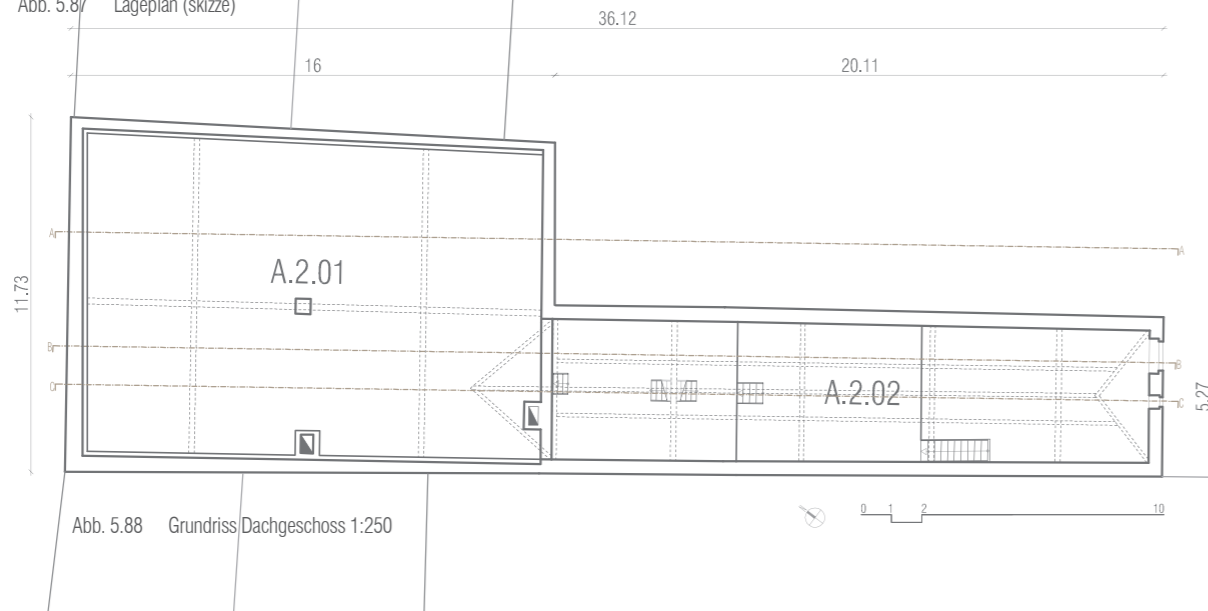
Grundriss Dachgeschoss 1:250
